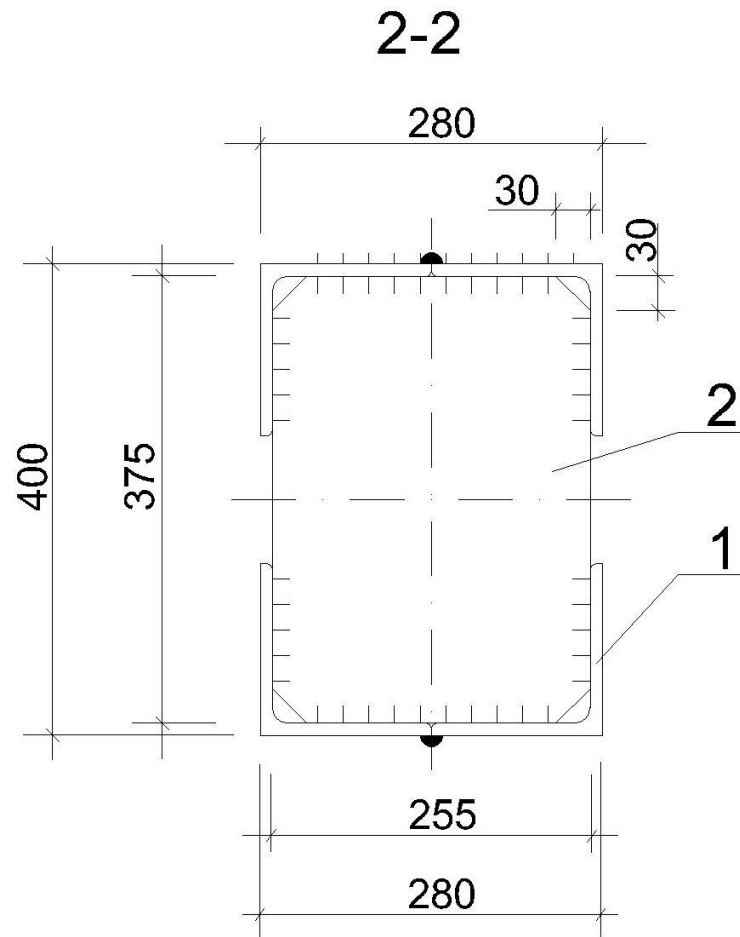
Поперечний переріз наскрізної двогілкової колони
